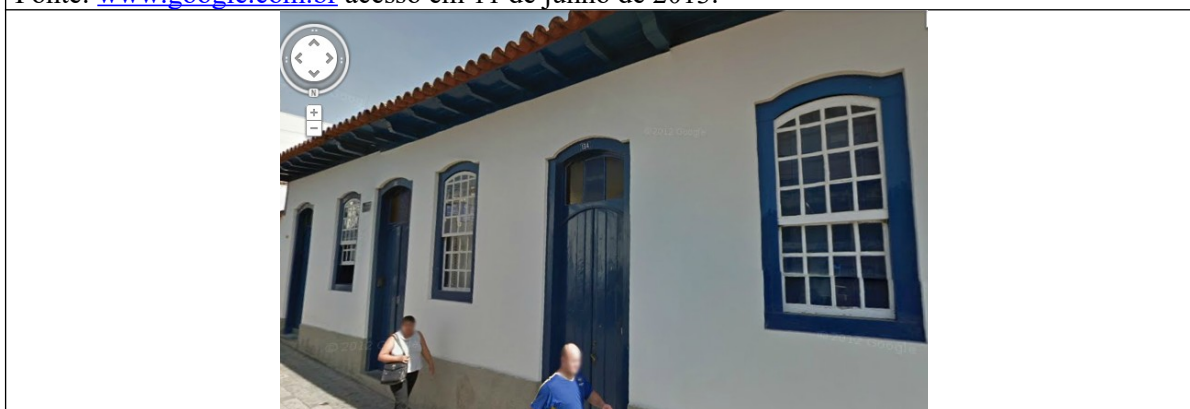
Vista da fachada frontal do imóvel objeto deste trabalho técnico.
